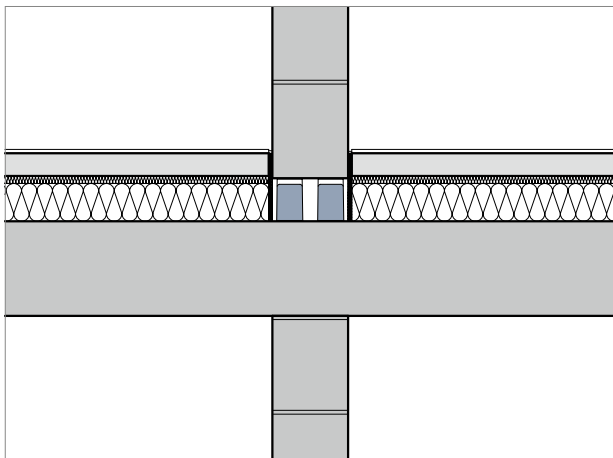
Schöck Sconnex® Typ M in Mauerwerk bei Innenwand und Aufdeckendämmung
